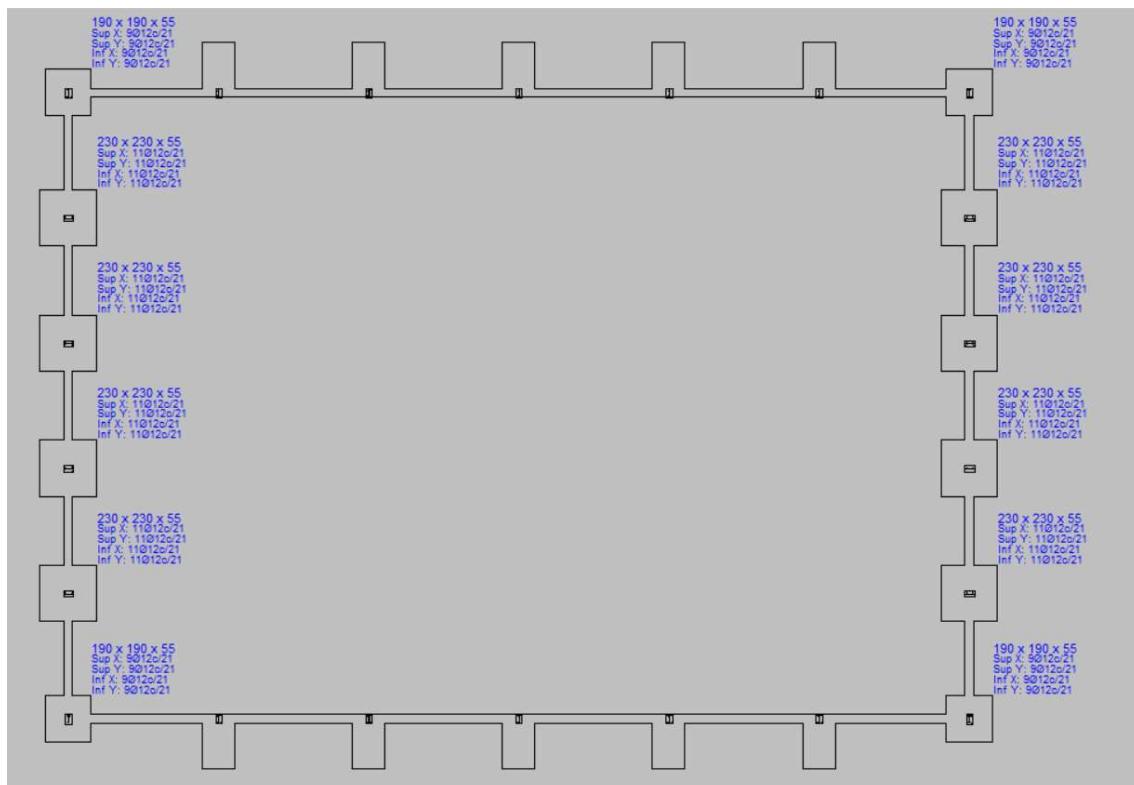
Distribución de las zapatas y vigas de atado nave empotrada.
